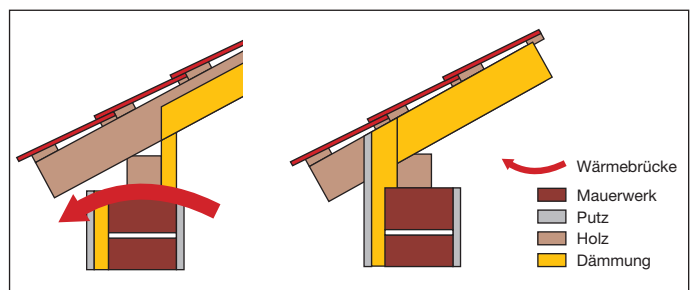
Anschlussdetail mit Wärmebrücke und Möglichkeit zur Behebung
